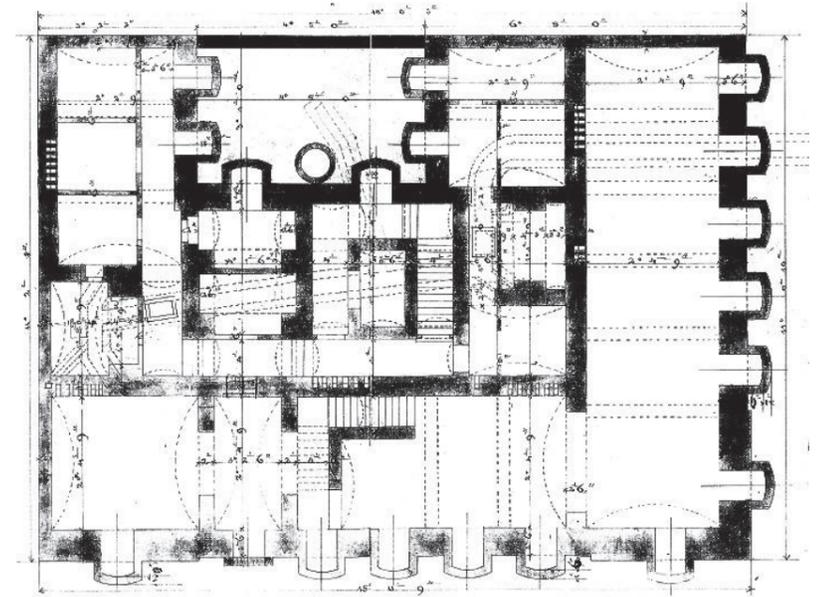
Grundriss Regelgeschoss, Block B
